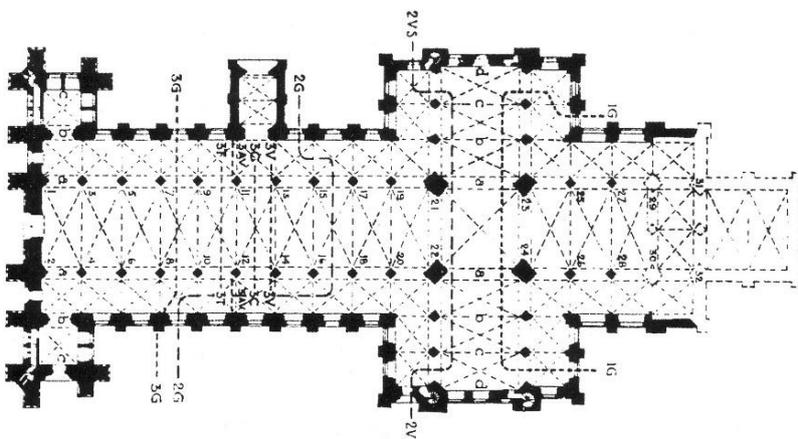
Wells, Kathedrale, Grundriss des frühgotischen Neubaus
